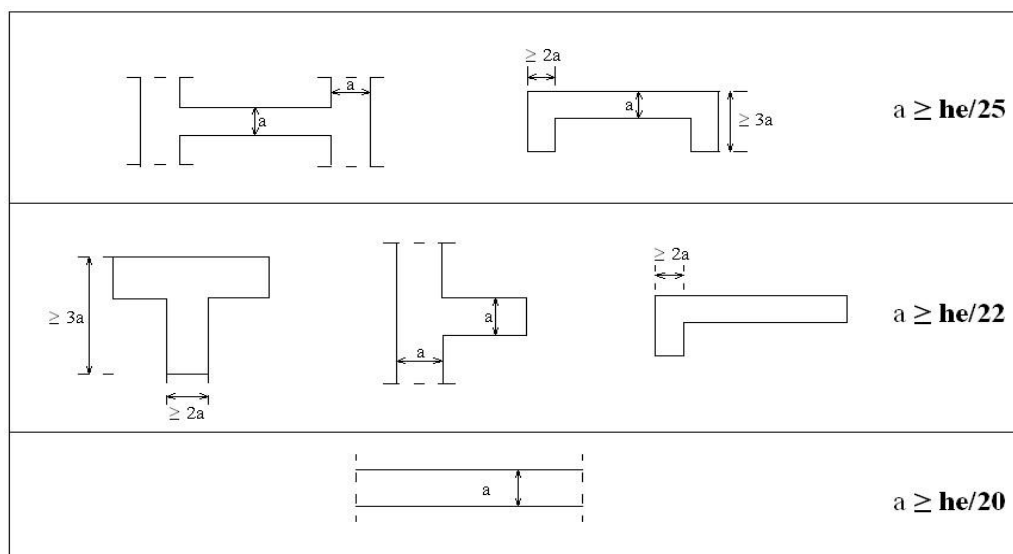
Coupes de voiles en plan (RPA 99 v 2003)
